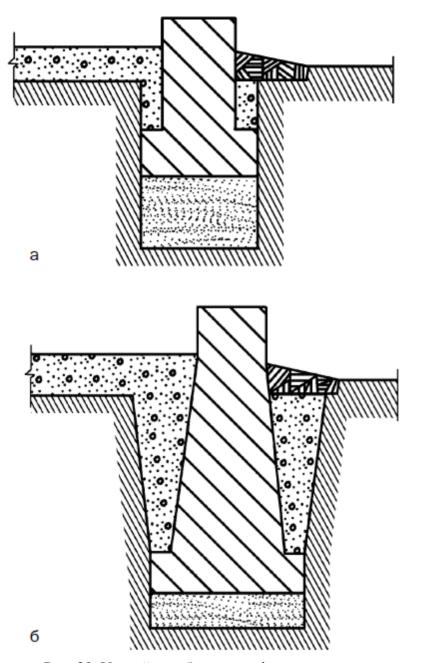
Устройство бетонного фундамента: а – ленточного; б – столбчатого
